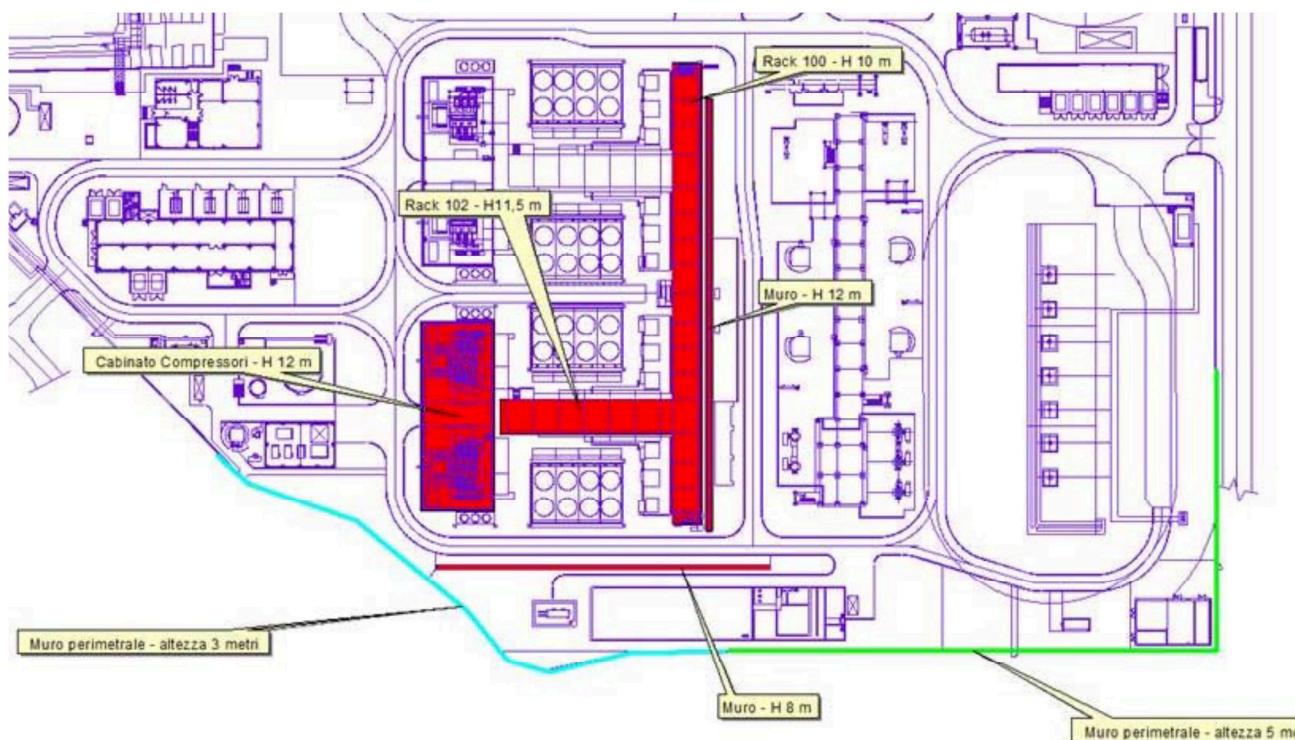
Vista in pianta con indicazioni di altezza degli elementi significativi. (il muro da sopraelevare con la barriera fonoassorbente è quello indicato in basso nella figura, con una linea orizzontale rossa)
